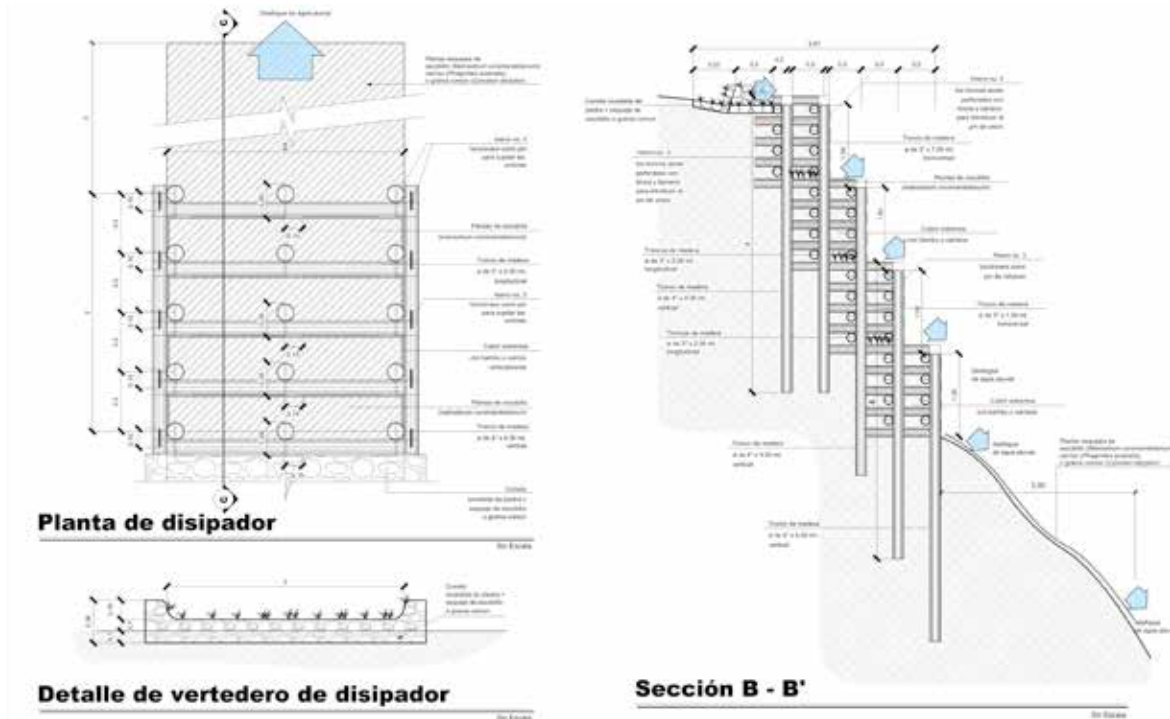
Detalle dissipador. Sección B-B'. Planificación Obra ORCC-02/RD-SOL-08.
